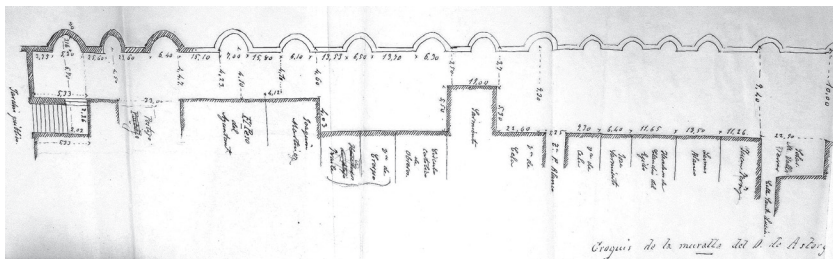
Croquis de la muralla de la zona Sur entre el Jardín y la calle de Santa Lucía. ADL, leg. 18.829, 18-VII-1907.
